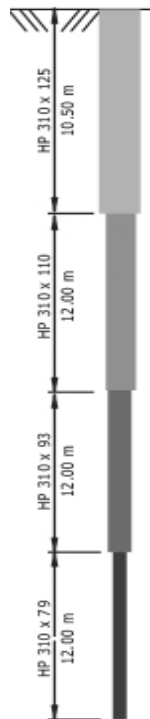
Ejemplo de pilote con sección decreciente en profundidad. Fuente: (Gerdau Corsa, n.d.)
